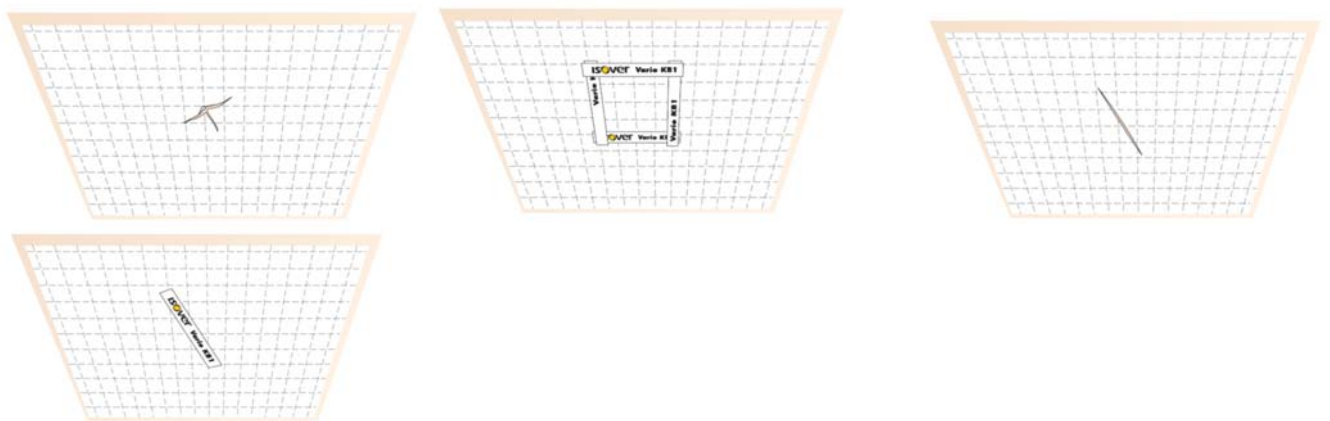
Réparation d'une déchirure (ou entaille de grande dimension) et réparation entaille de petite dimension
